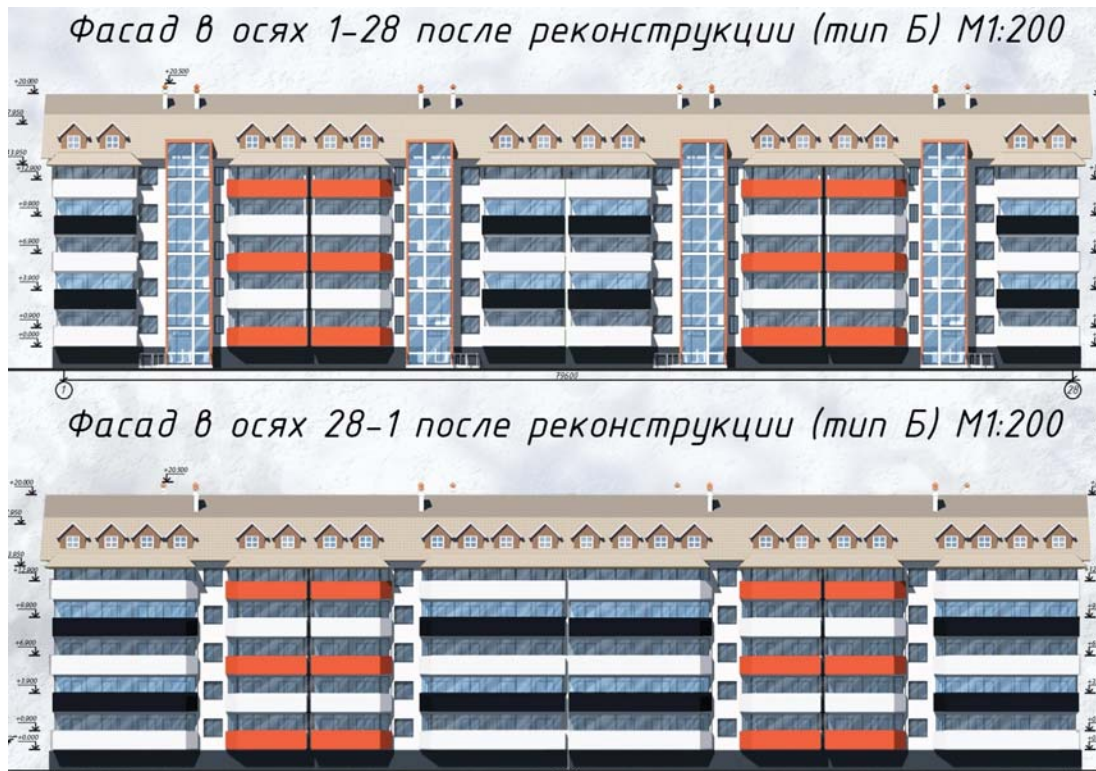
Экспериментальный проект архитектурно-градостроительной реконструкции жилого квартала в городе Донецке – фасады в осях 1-28 и 28-1 5-этажных жилых зданий (после реконструкции)
